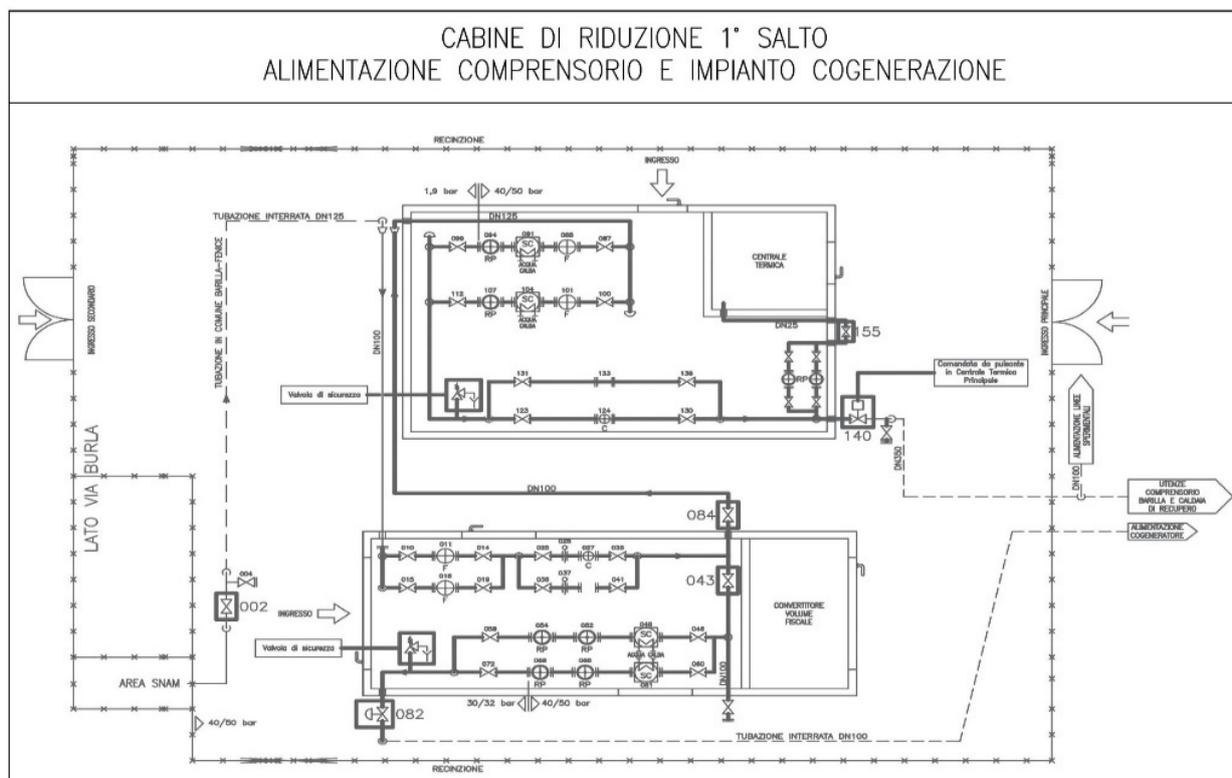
Schema alimentazione rete gas Comprensorio
